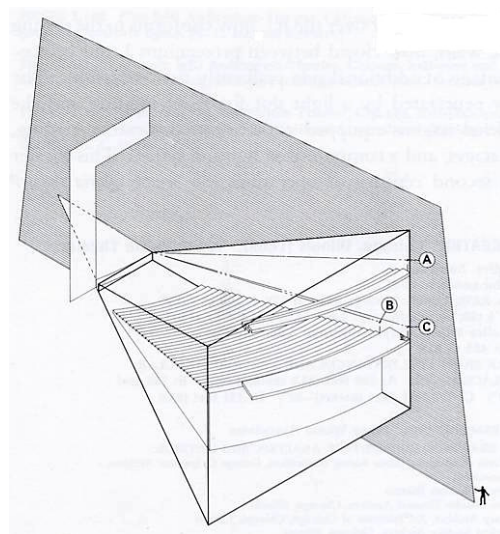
Schema assometrico dell'auditorium del Bayereuth Festspielhaus.
